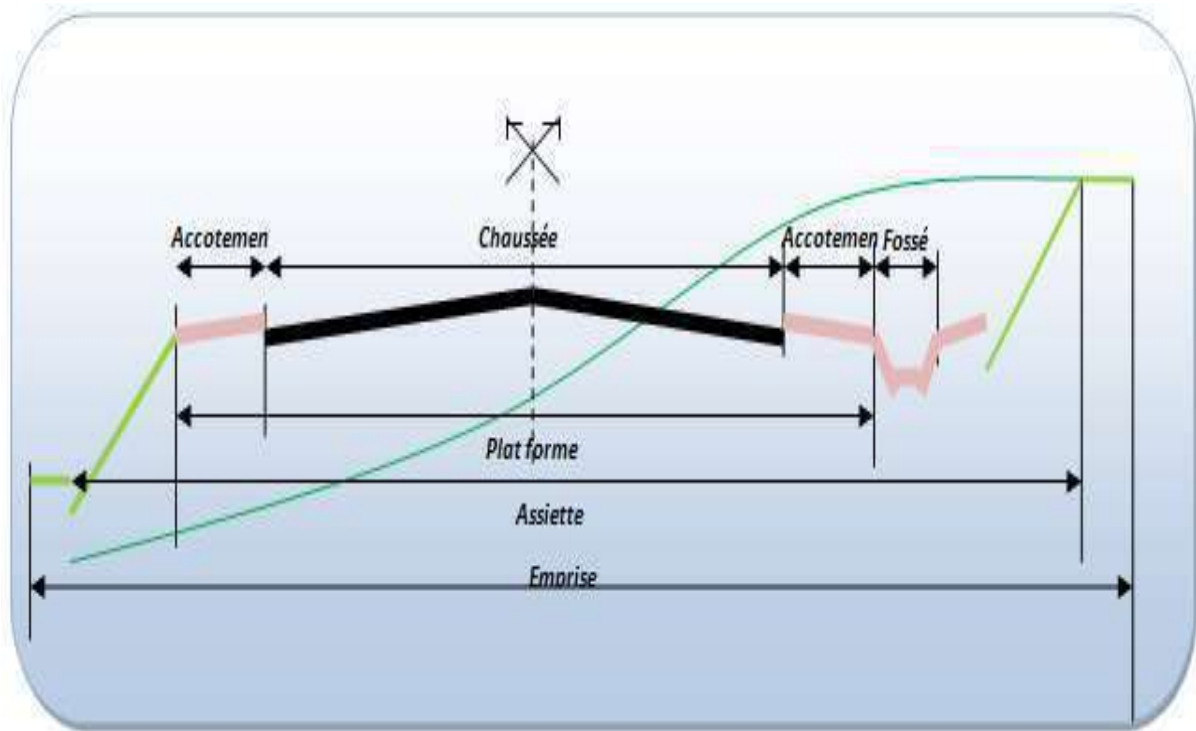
Les Eléments Constitutifs Du Profil En Travers [19]
